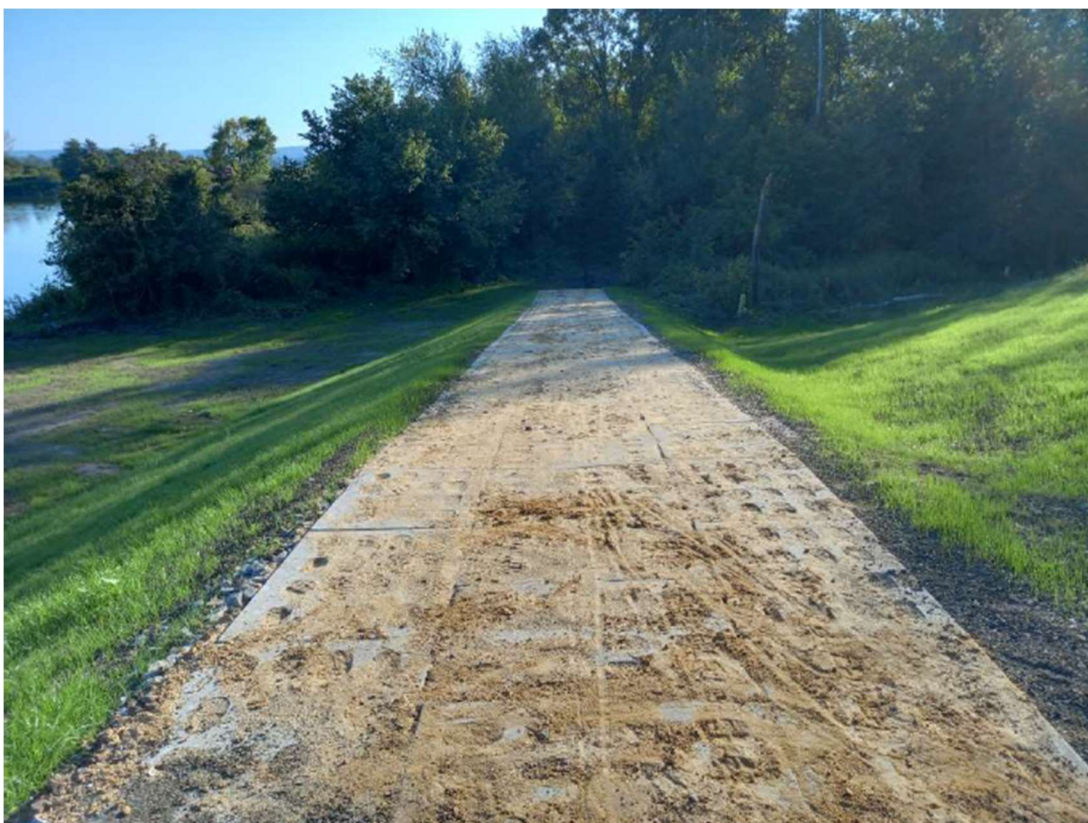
Przebudowany południowy zjazd z wału przeciwpowodziowego na zachodnim brzegu kanału portu Kujawy, stan w trzeciej dekadzie września 2023 r. (widok w kierunku południowym).
